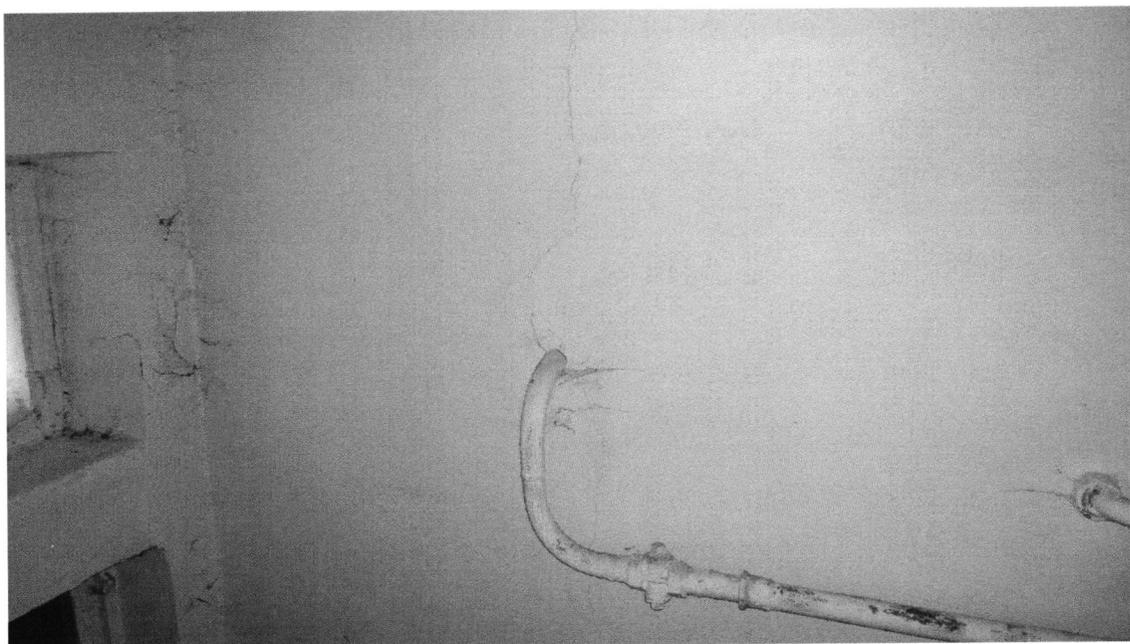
Трещина в кирпичной кладке лестничной клетки высотой в два этажа. Берёт начало в месте прохождения газовой трубы через стены и заканчивается в надоконной зоне, ширина раскрытия 1...2 мм.
